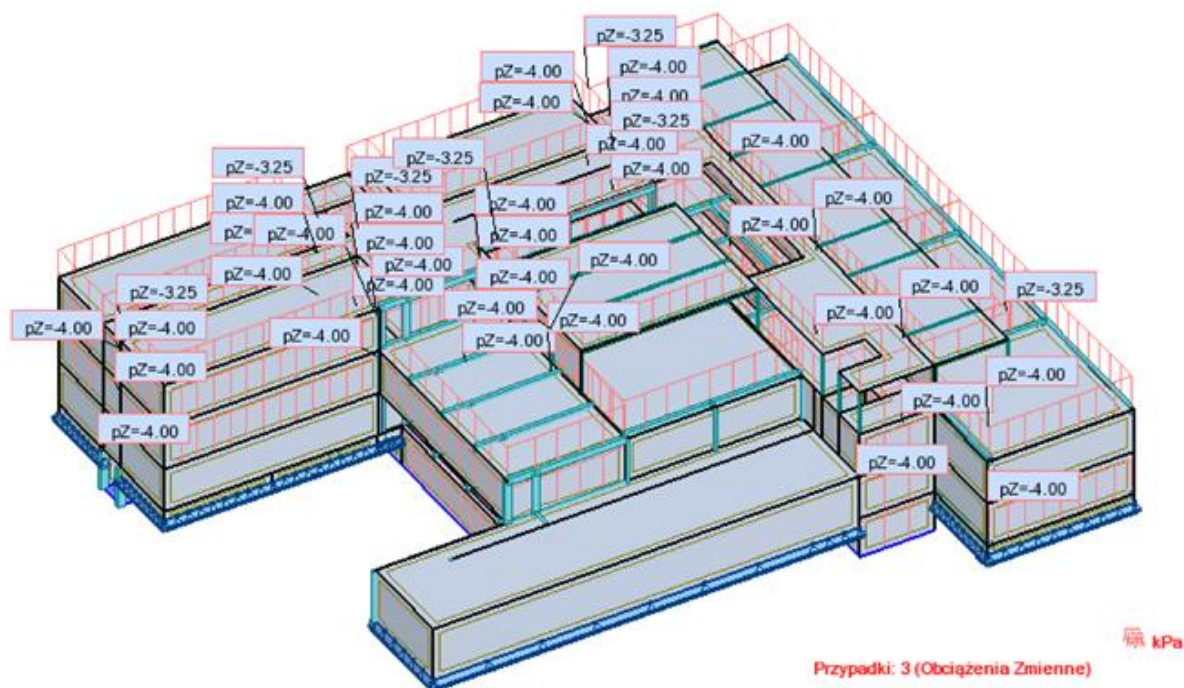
Przestrzenna rama żelbetowa, elementy prętowe (kolor jasnoniebieski).
